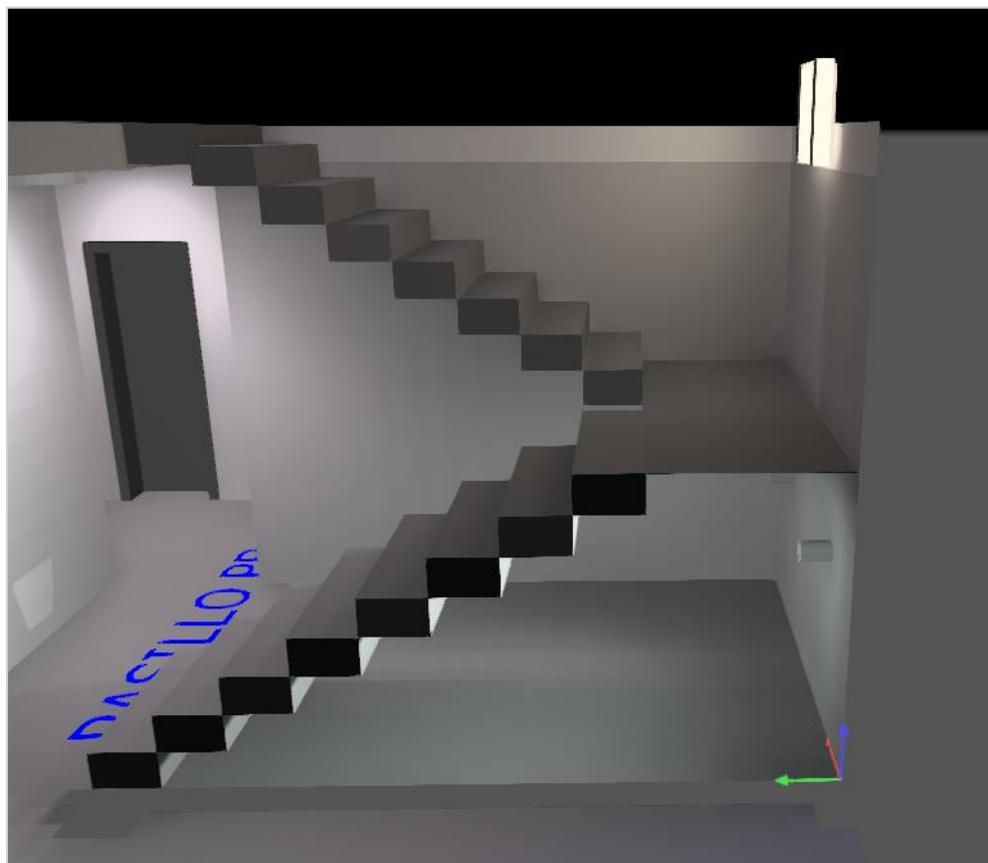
Situación luminarias de las escaleras de la planta baja (fuente propia).
